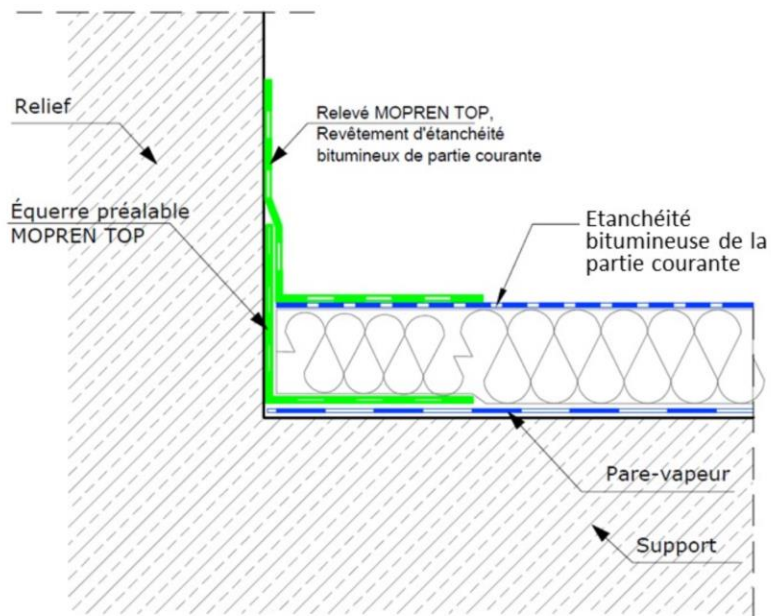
Equerre préalable MOPREN TOP sur élément porteur béton
